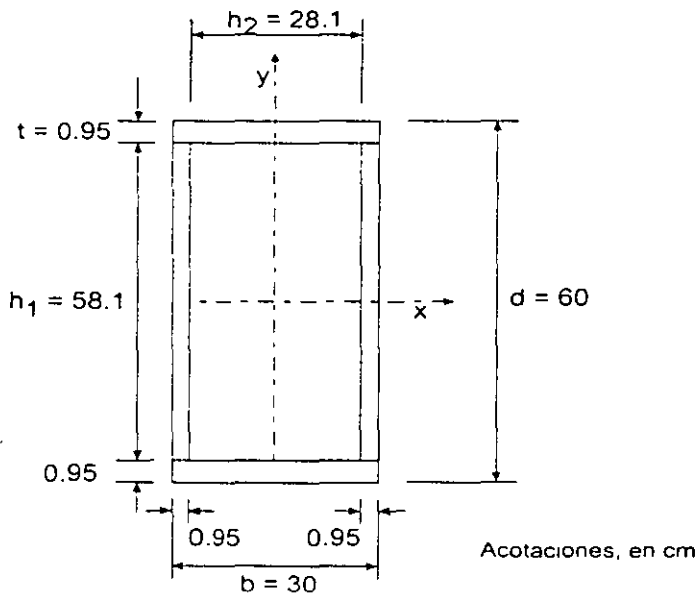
Sección transversal de la columna del ejemplo 2.5.
